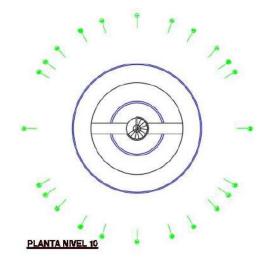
Planta del décimo nivel. (Fuente Autor)
